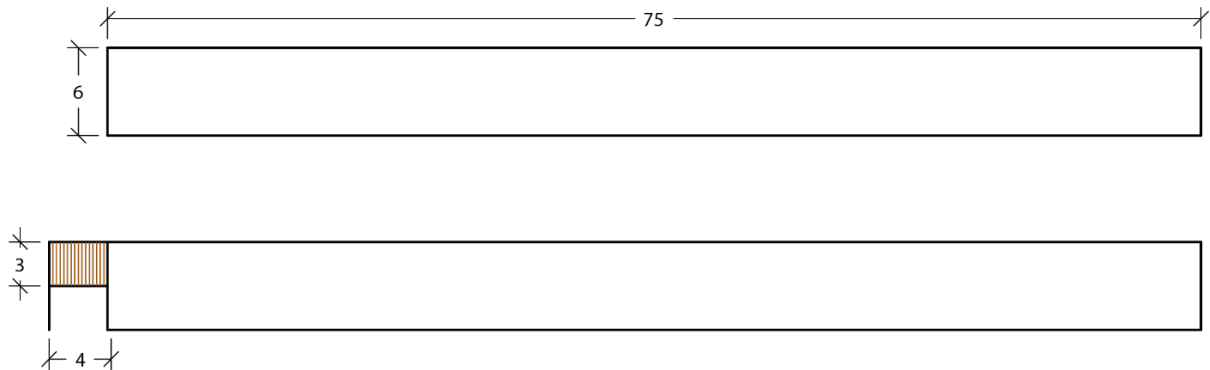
Vista em alçado das fachadas laterais (com e sem pórtico)
